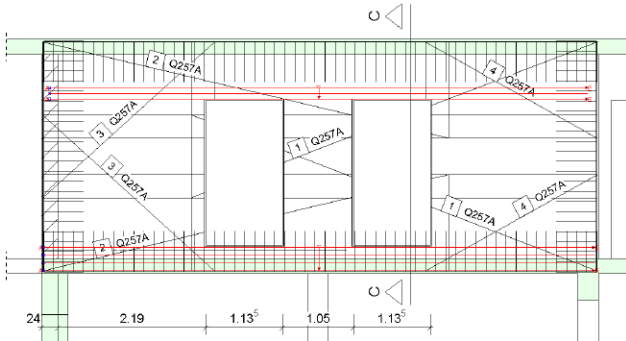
Angepasste Längsbewehrung über- und unterhalb der Aussparungen
